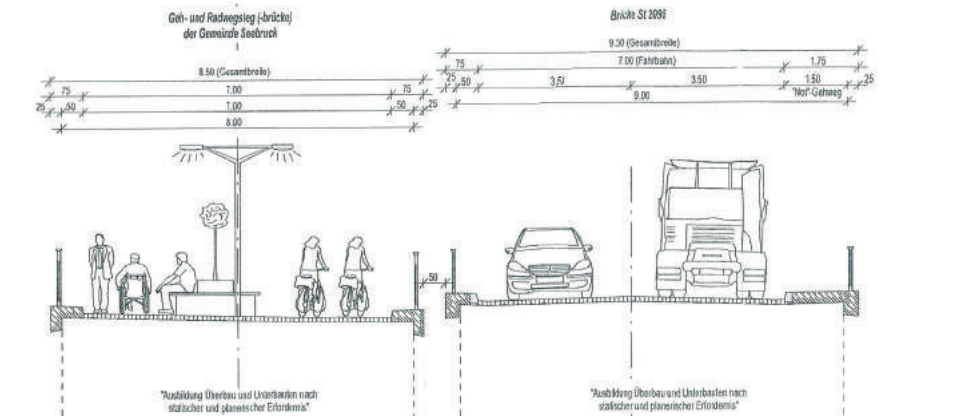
Entwurf für mögliche Ausführung bei Variante B - Neue Brücke neben Bestand
